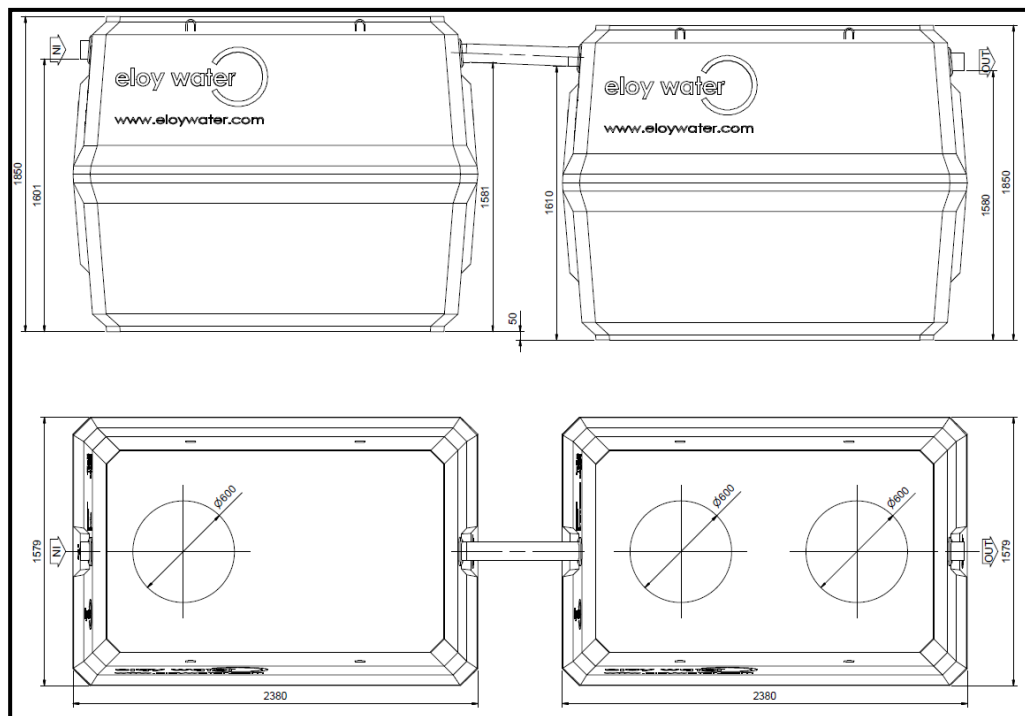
Plan d'encombrement des Oxyfix® C-90 7 et 8-9 EH (2)
